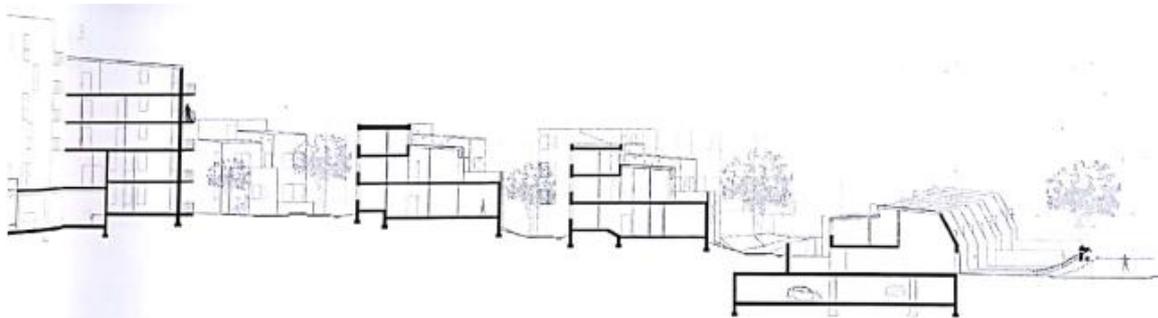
Section verticale sur l'habitat collectif, intermédiaire et individuelle
